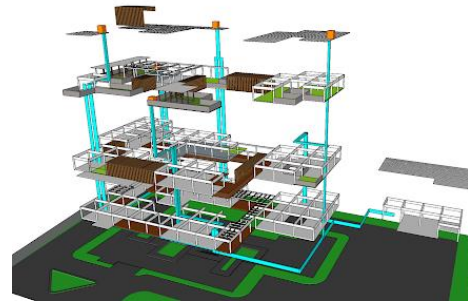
4. Sistem struktur rangka konstruksi bangunan.
